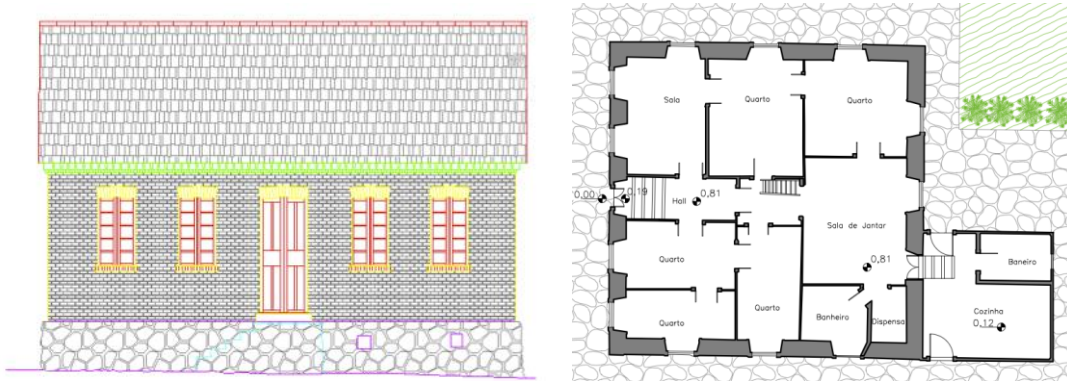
Exemplos de planta de fachada (esq.) e planta baixa (dir.).
